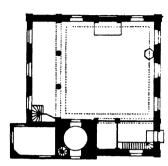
St. Benet church, Thamesstreet zu London. Grundriss.
